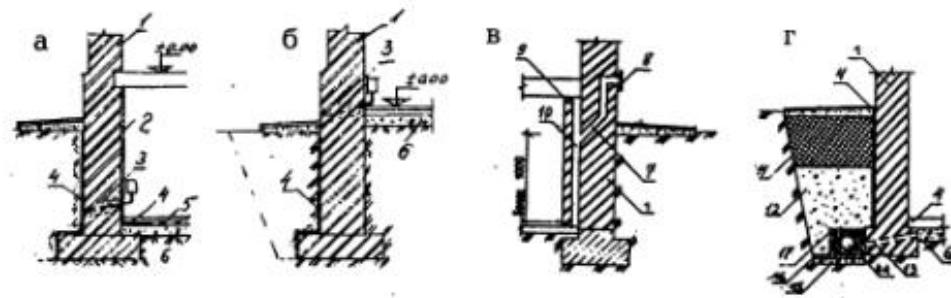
Защита стен от замачивания: а – нагнетением гидроизолирующего раствора в стены подвала; б – то же, в стены цоколя (при полах по грунту); в – осушающей вентиляцией стен подвала; г – пристенным дренажом; 1 – осушаемая стена; 2 – санитарующая штукатурка; 3 – гидроизолирующий раствор; 4 – оклеенная двухслойная рулонная гидроизоляция; 5 – пол подвала; 6 – бетонная подготовка; 7 – вентиляционный канал в стене; 8 – вентиляционная решетка; 9 – дополнительная стенка; 10 – воздушная щель; 11 – уплотненный грунт; 12 – гравийно-песчаная смесь; 13 – отводной канал; 14 – дренажная труба; 15 – щебень, втрамбованный в грунт; 16 – глинобетон; 17 – крупный щебень.
